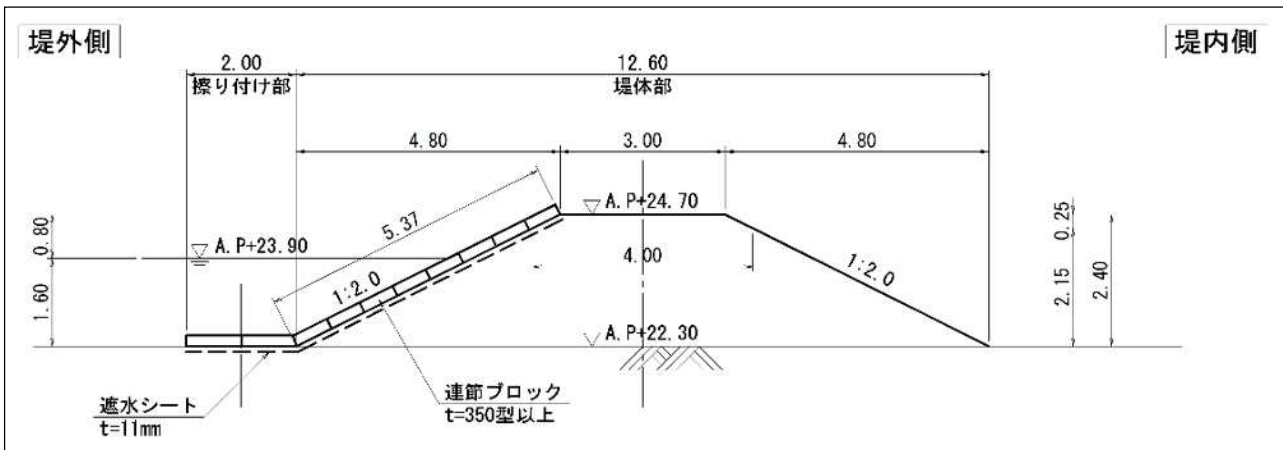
仮締切堤標準断面図 (1 期・2 期共通)
